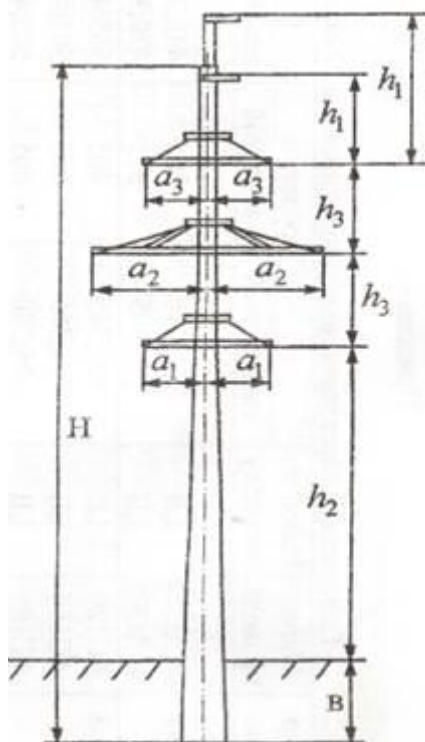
Унифицированная железобетонная опора ПБ110-8
